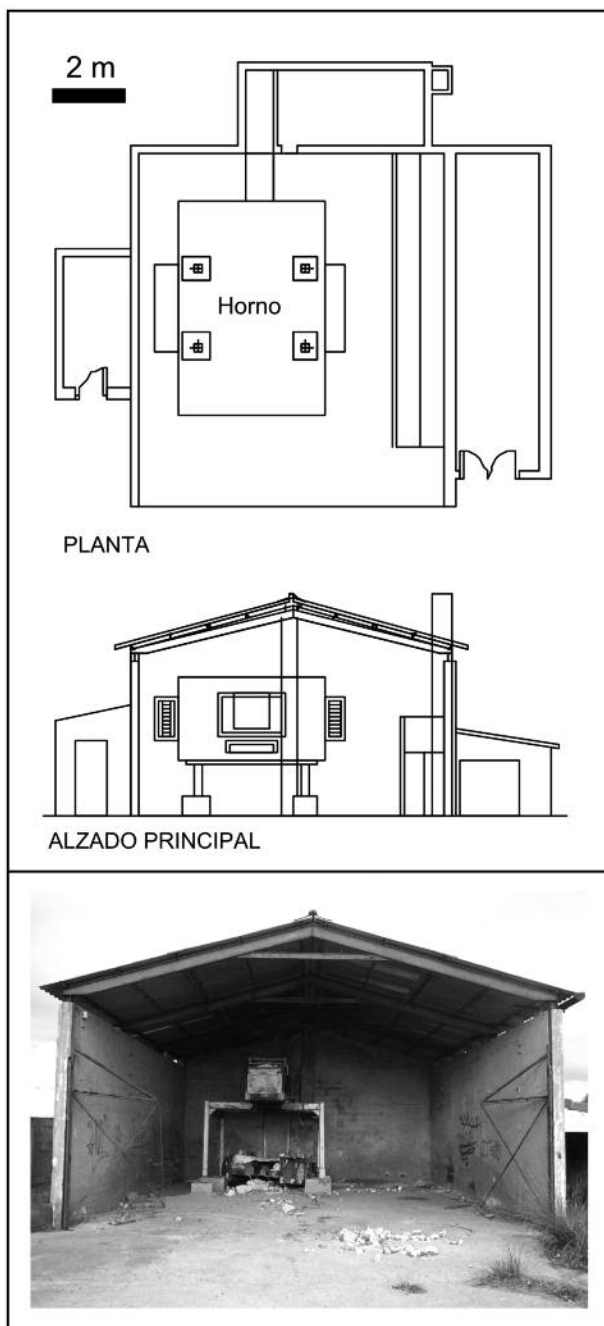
Planta y alzado del edificio del horno auxiliar tras su recuperación y reconstrucción. Debajo se muestra una fotografía de su estado actual.
